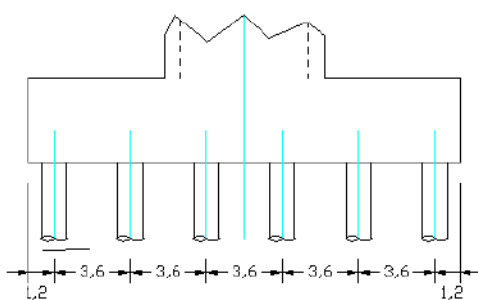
Vue dans le sens longitudinal de la fondation.
